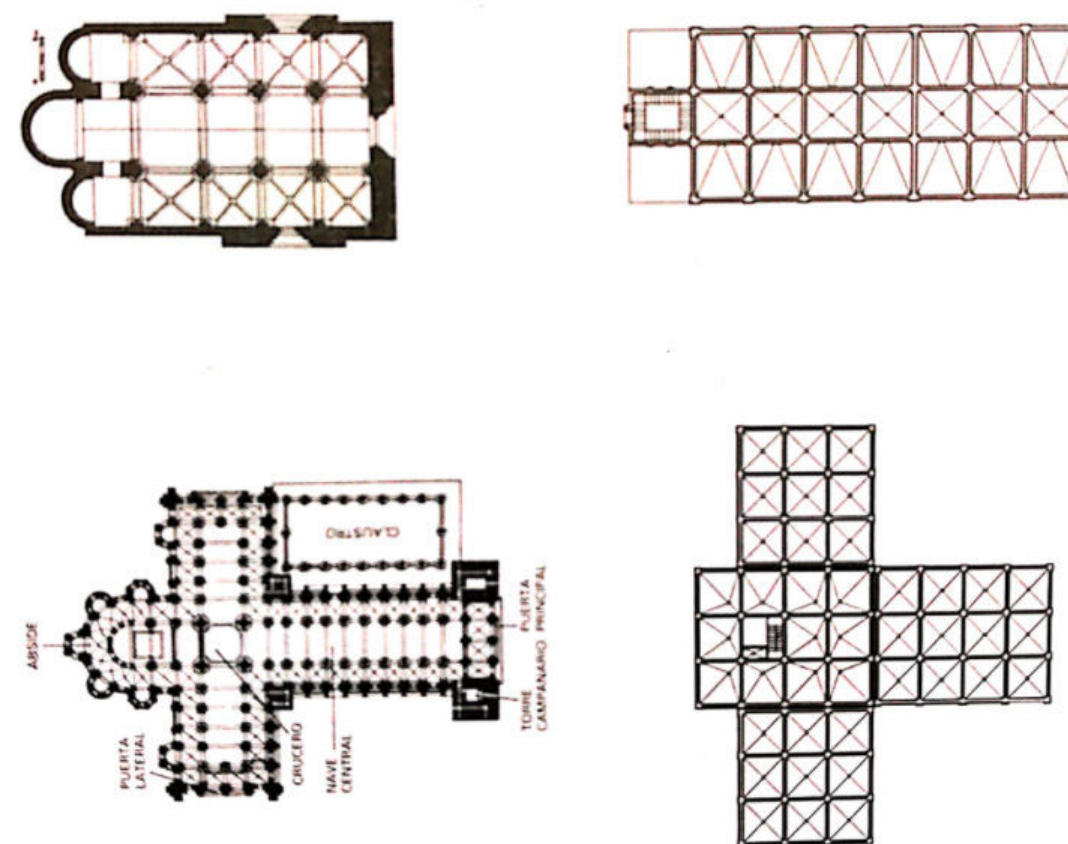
COMPARACIÓN PLANTA TIPO DE BASÍLICA Y CATEDRAL CON PLANTA TIPO DE SILO.
